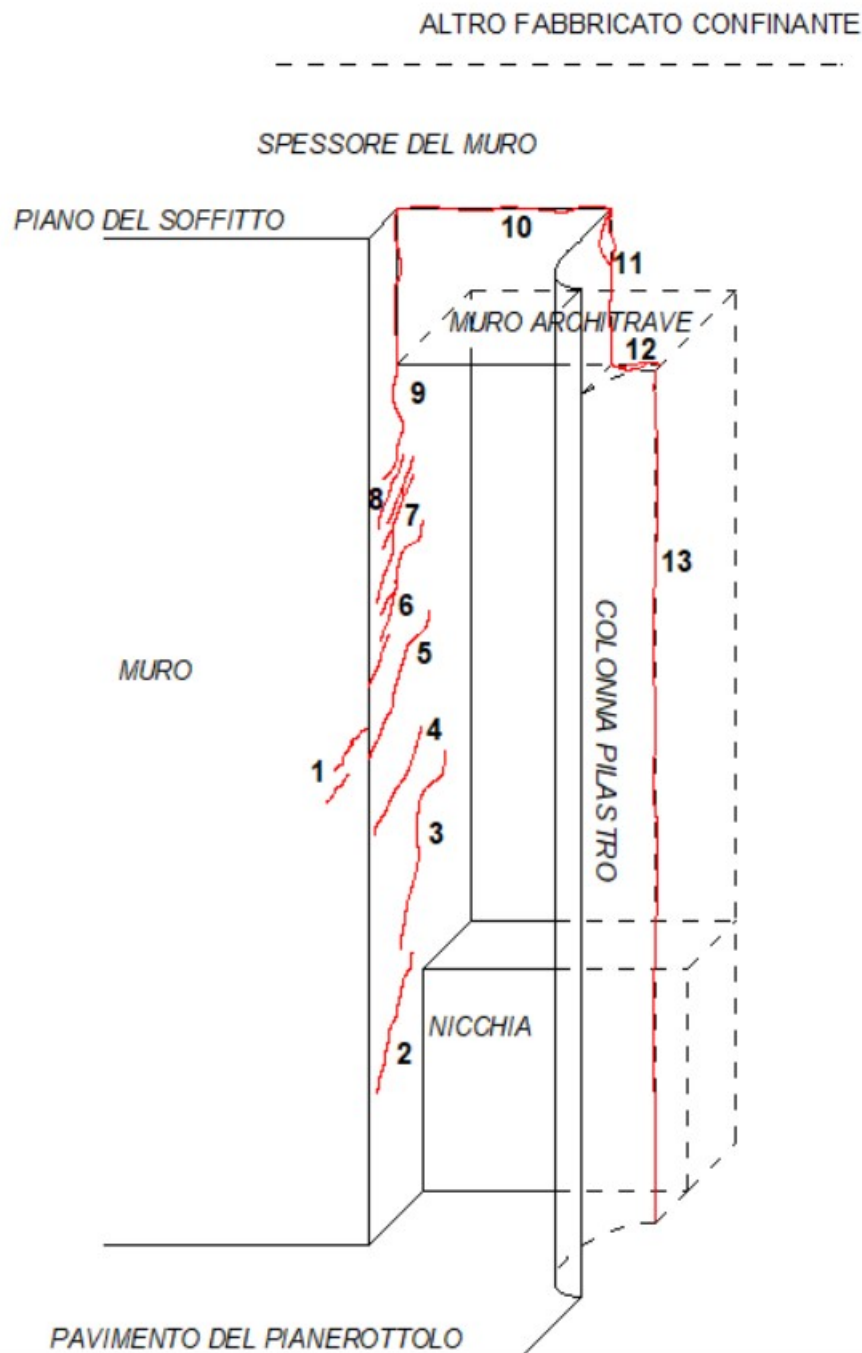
Assonometria obliqua del quadro fessurativo e delle discontinuità murarie rilevate nell'appartamento della signor
